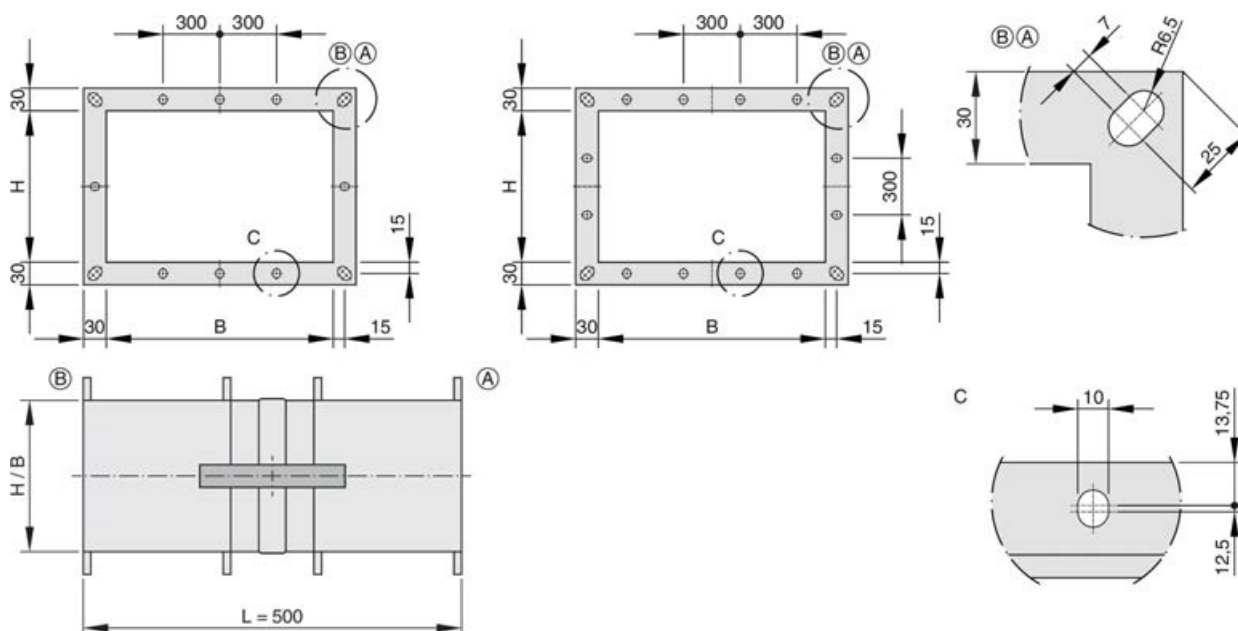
Flangehuller L = 500 mm – ulige og lige antal huller
